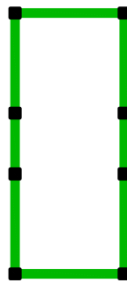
Seções de vigas das casas de máquinas decorrentes do pré-dimensionamento
